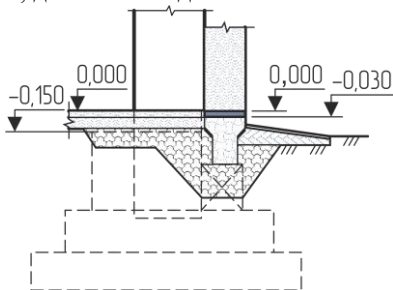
Схема расположения фундаментной балки и нижней стеновой панели
